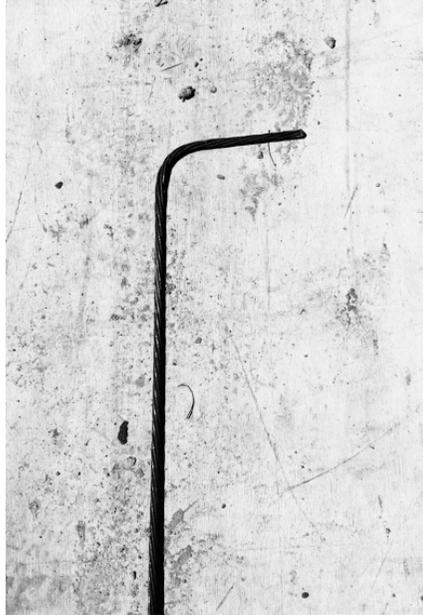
Gancho para anclaje embebido en cemento de torón de 3/8.
